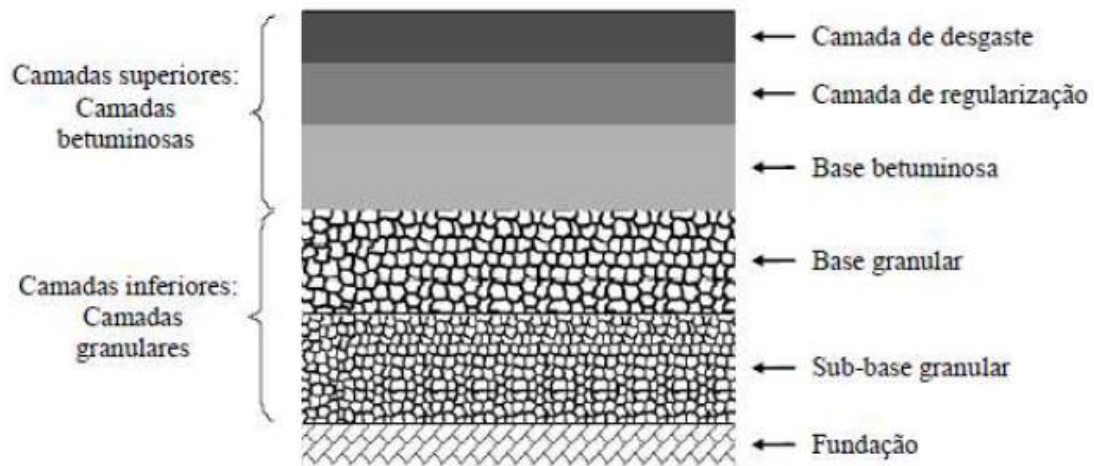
Diagrama esquemático da estrutura de um pavimento rodoviário. (Balbo 2007)
